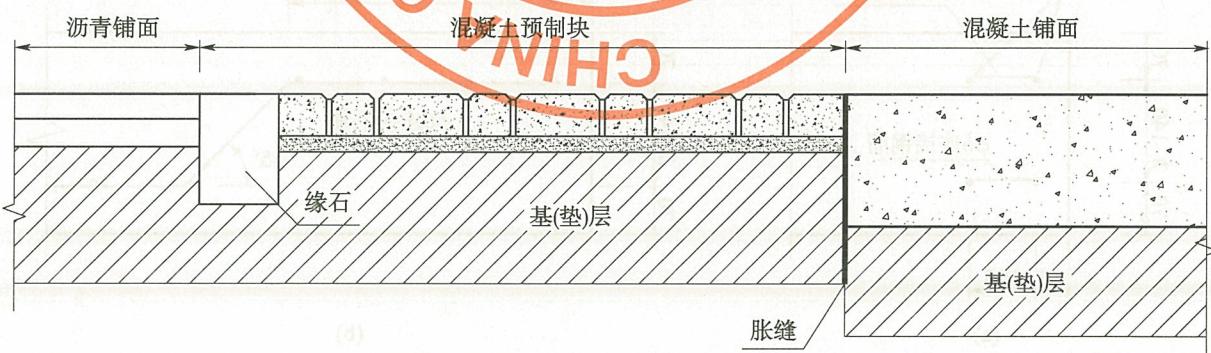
混凝土铺面与沥青铺面相接段的简易处理
